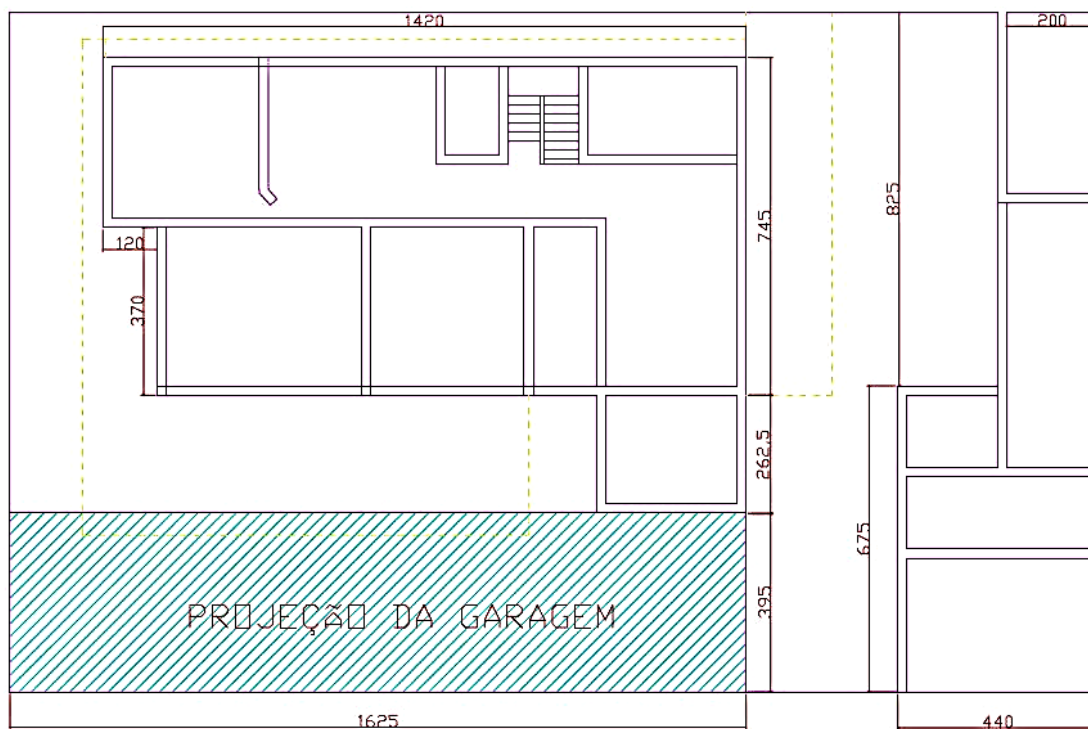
Croqui do 1º pavimento com projeção da garagem destacando a área com Padrão Construtivo Normal
